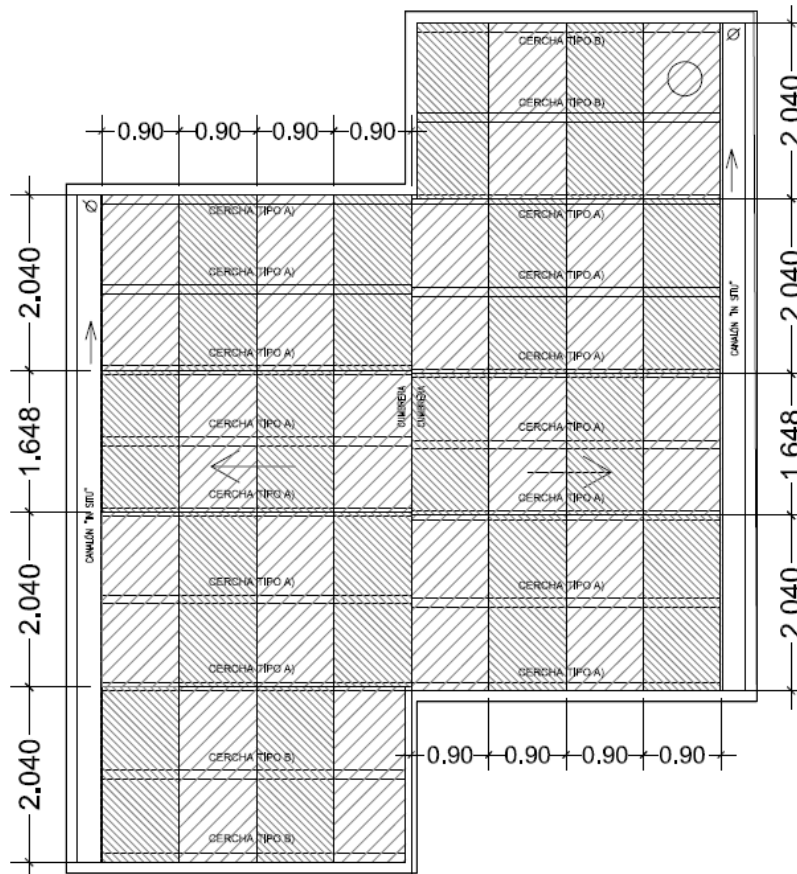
Disposición de los tableros y las cerchas/vigas de cubierta / [EP]
